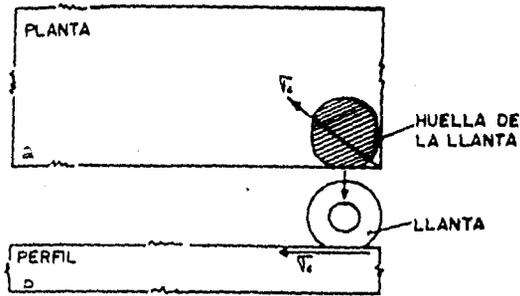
Esfuerzos de tensión que se presentan en pavimentos rígidos en el caso que la huella de una llanta sea tangente a dos orillas de una losa, (a) planta, (b) sección (esfuerzos de esquina).
